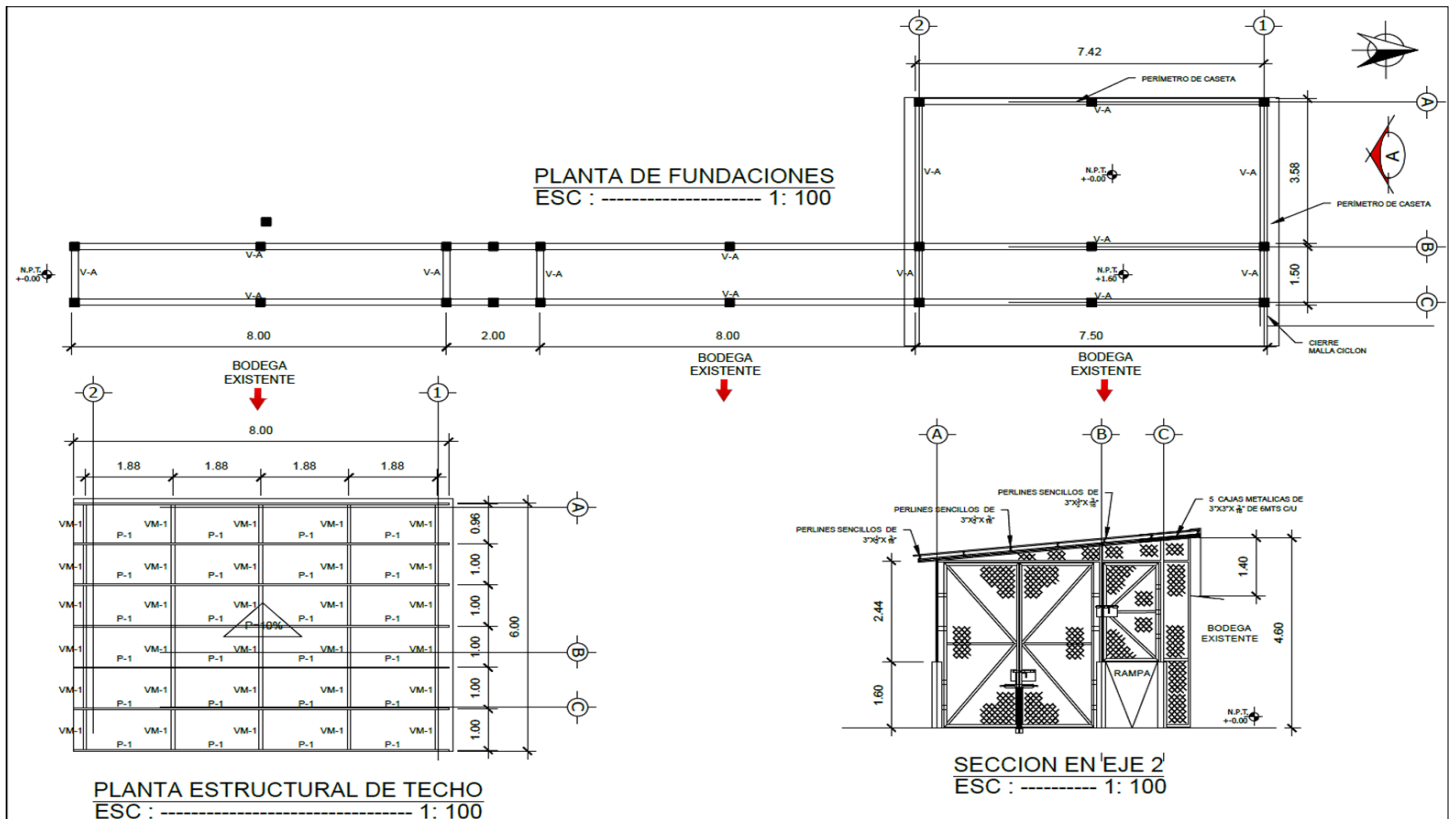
Planta de fundaciones, planta estructural de techo y elevación/ Fuente: Elaboración propia.
